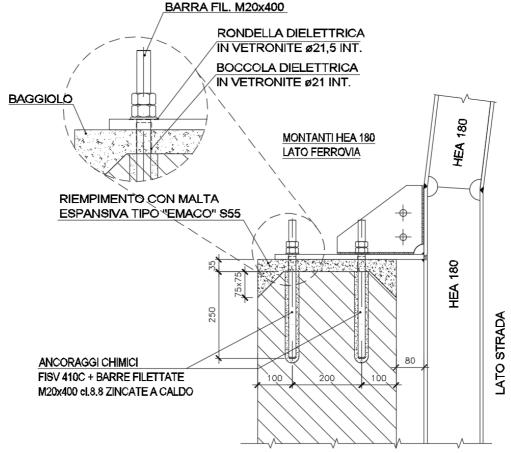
Dettaglio del collegamento superiore HEA180 barriera lato ferrovia
